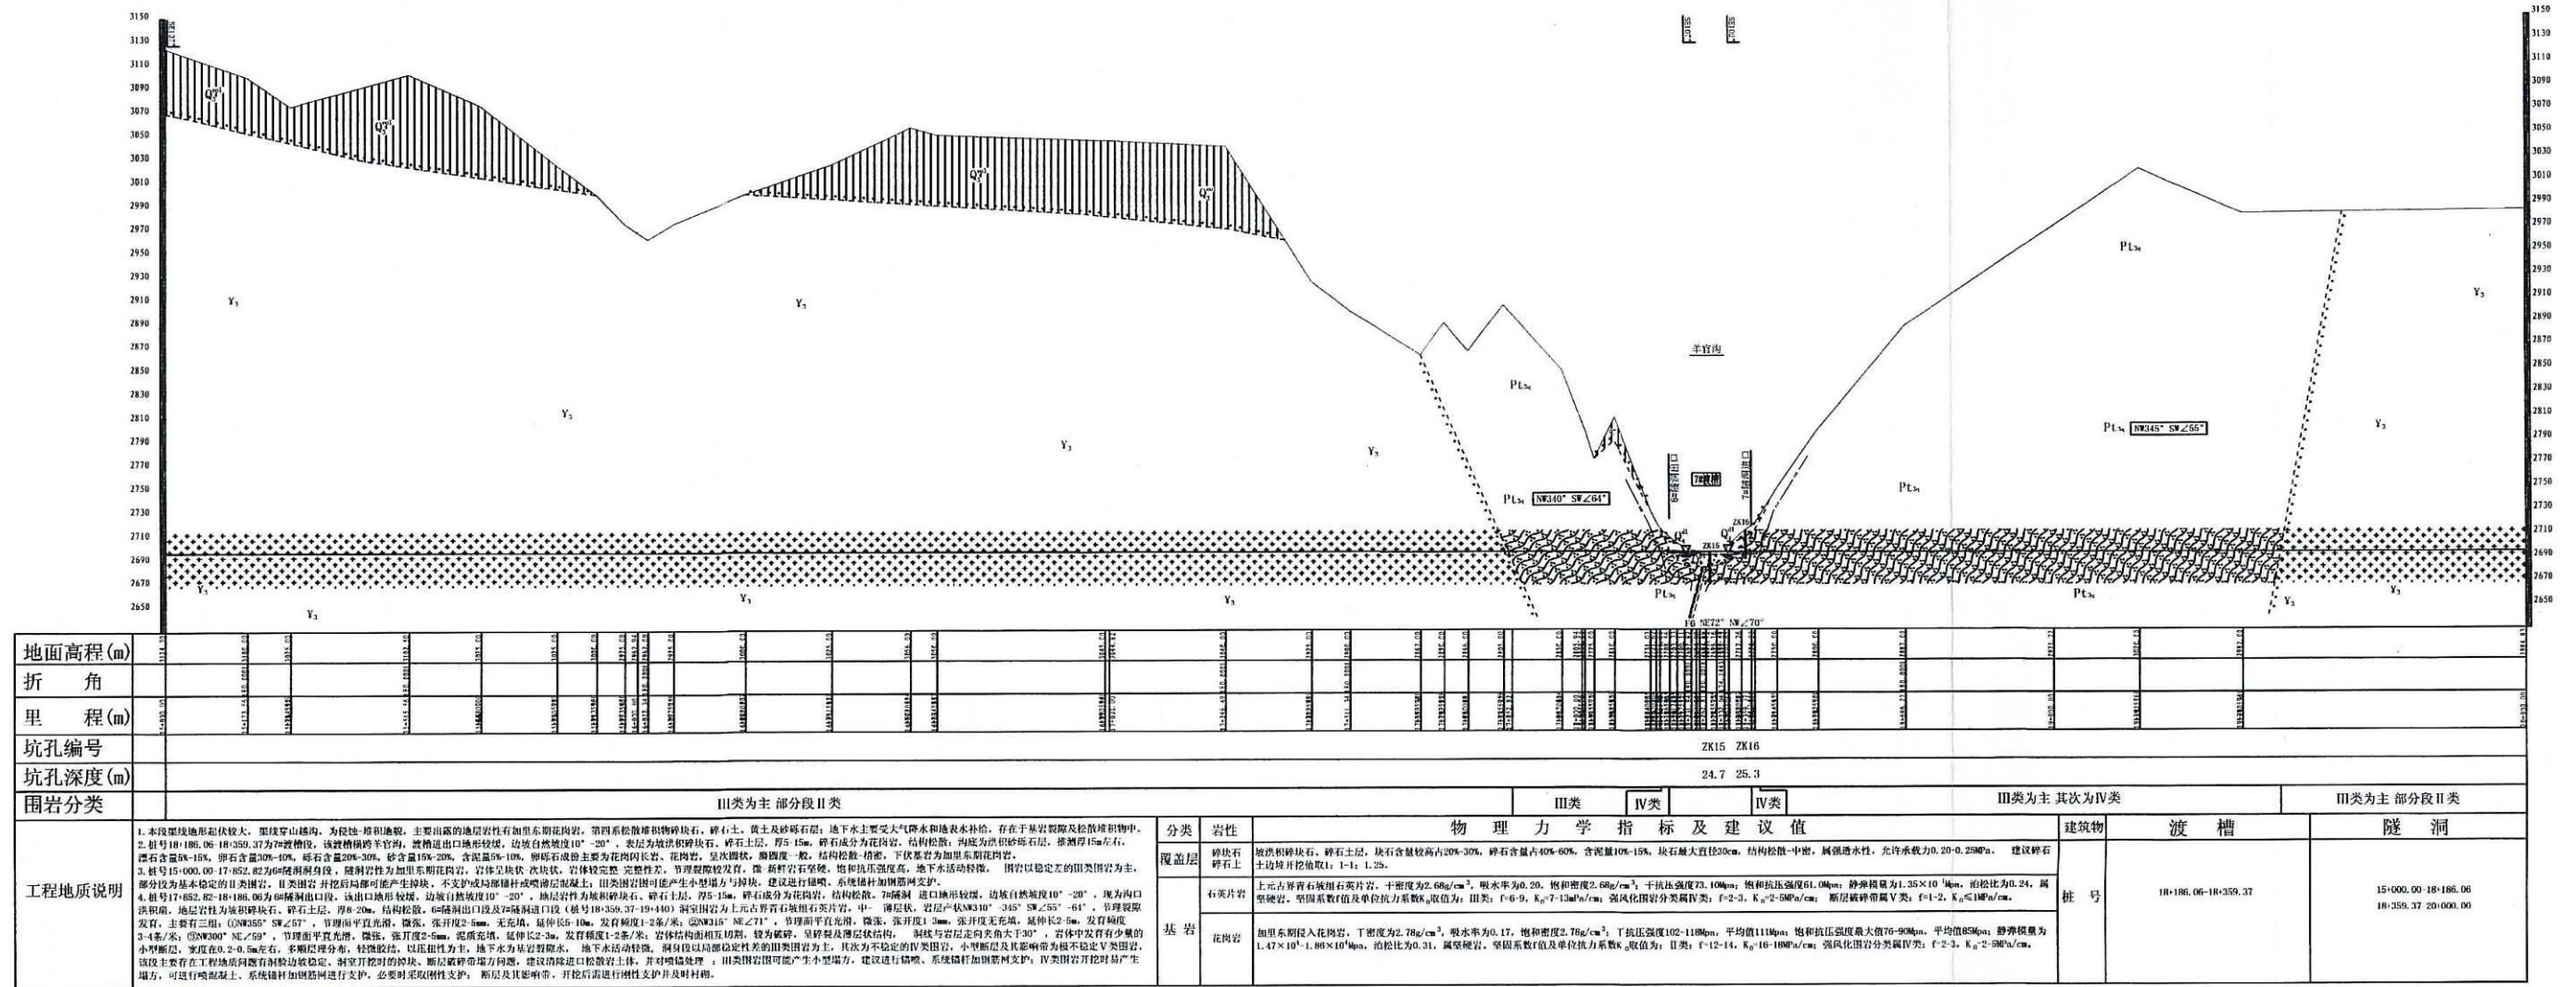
三分干 6#隧洞后段和 7#隧洞前段工程地质剖面图
